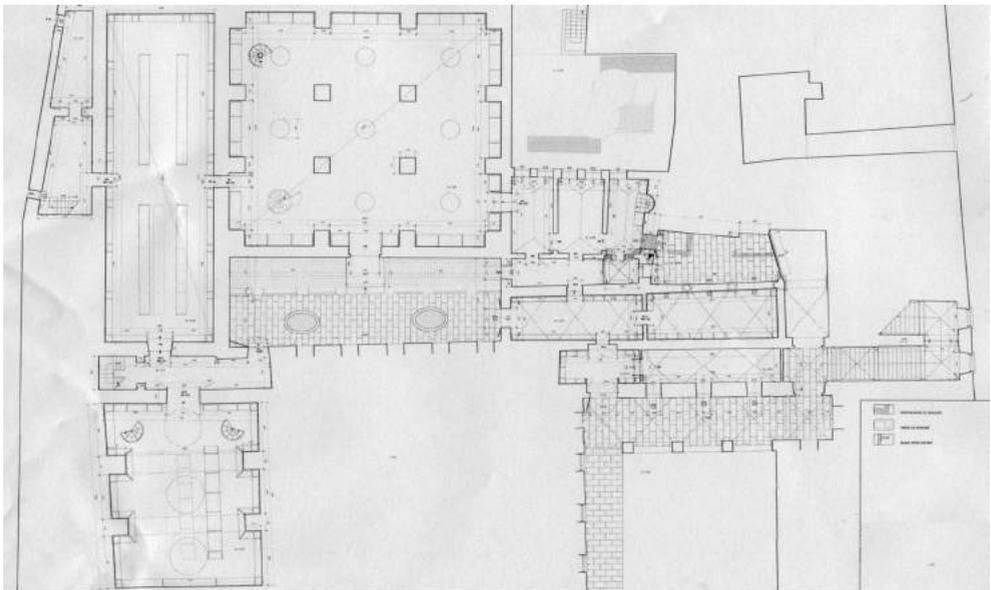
N.G. Leone, G. Militello, *Progetto e direzione dei lavori di restauro dell'Archivio Storico Comunale di Palermo, (1998-2001)*. Pianta del piano terra; disegno c.a.d., stampa su lucido, rapp.1:50.
